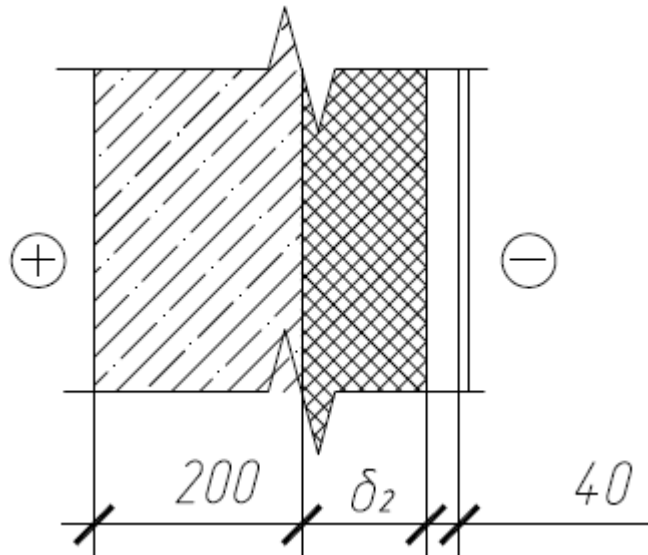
Конструкция наружной стены лестничной клетки
